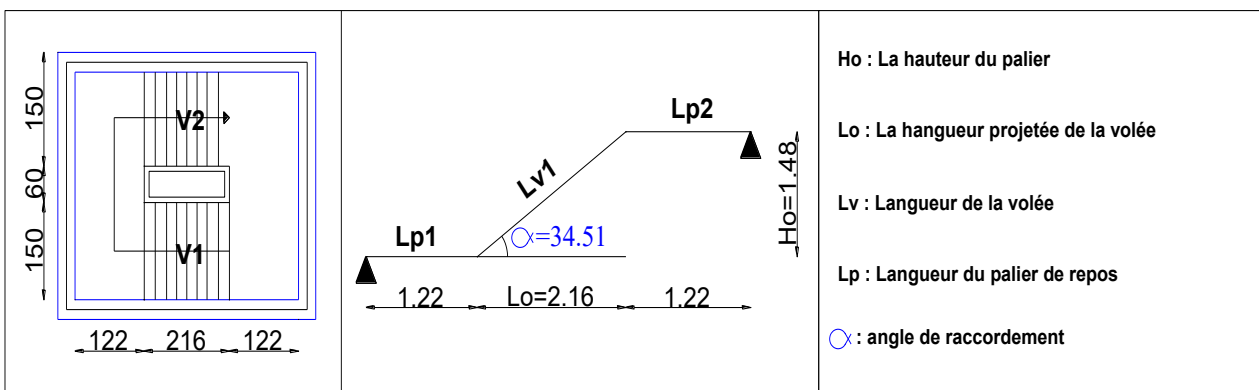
Vue en plan d'un escalier droit à deux volées et son schéma statique.
